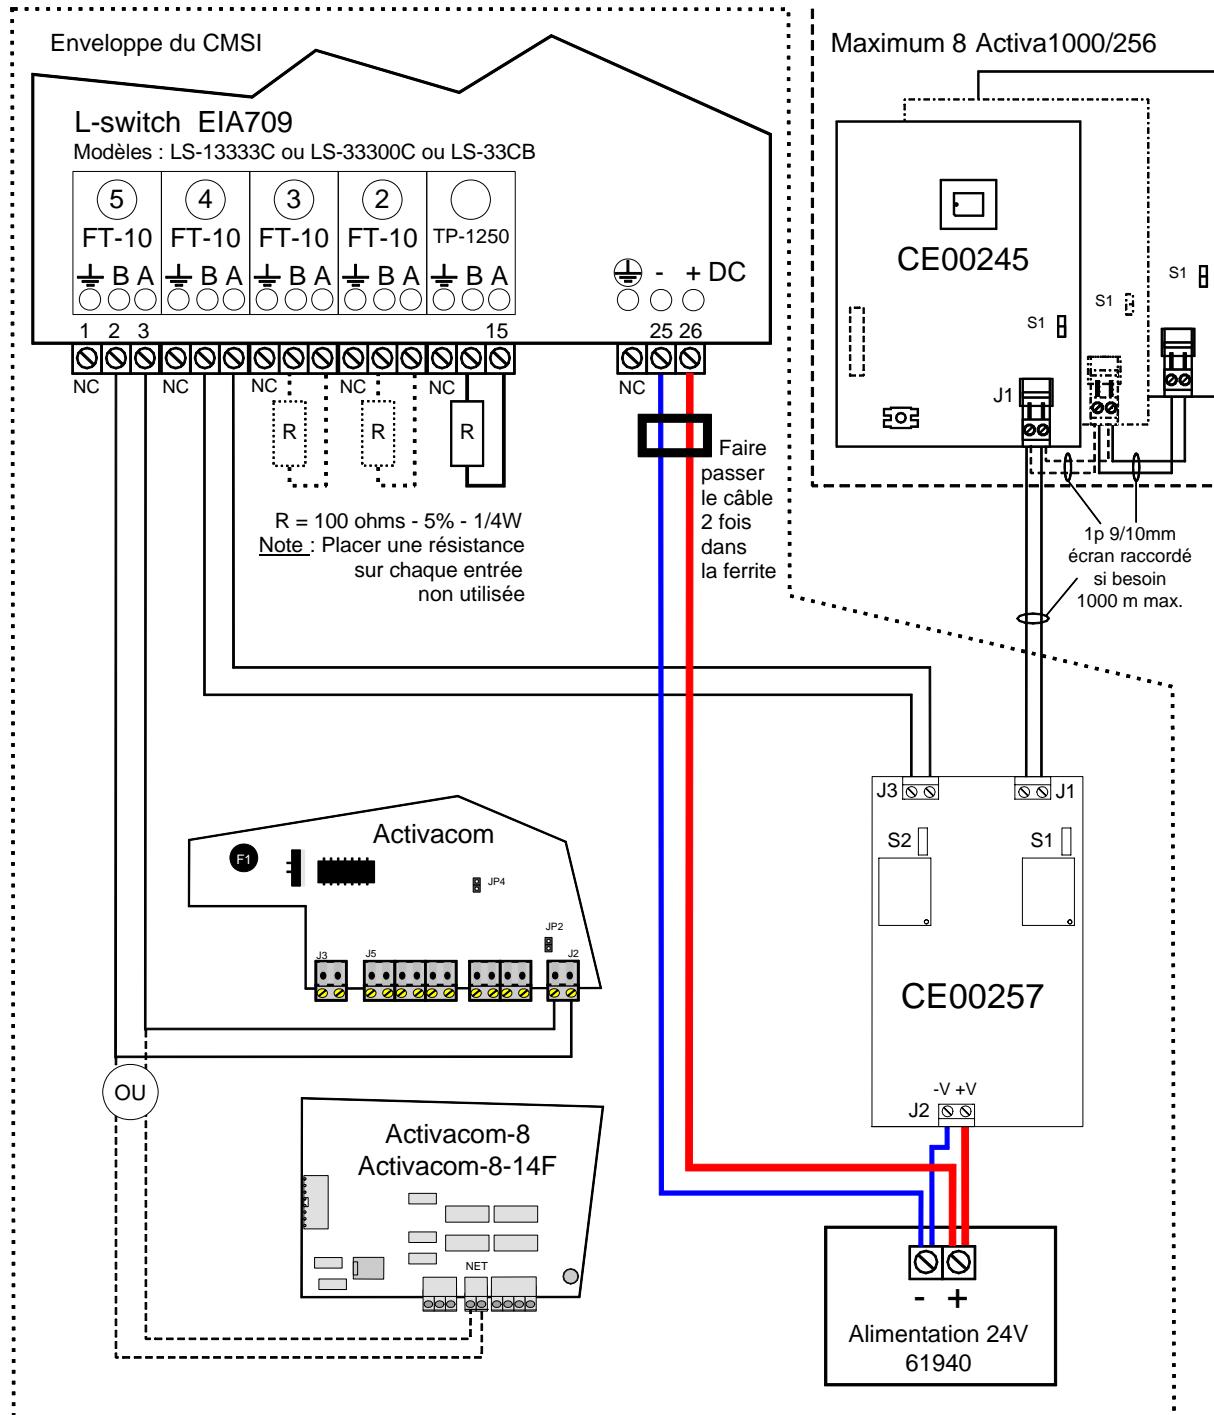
[PC372111] : raccordement d'un routeur sur la liaison SDI.
